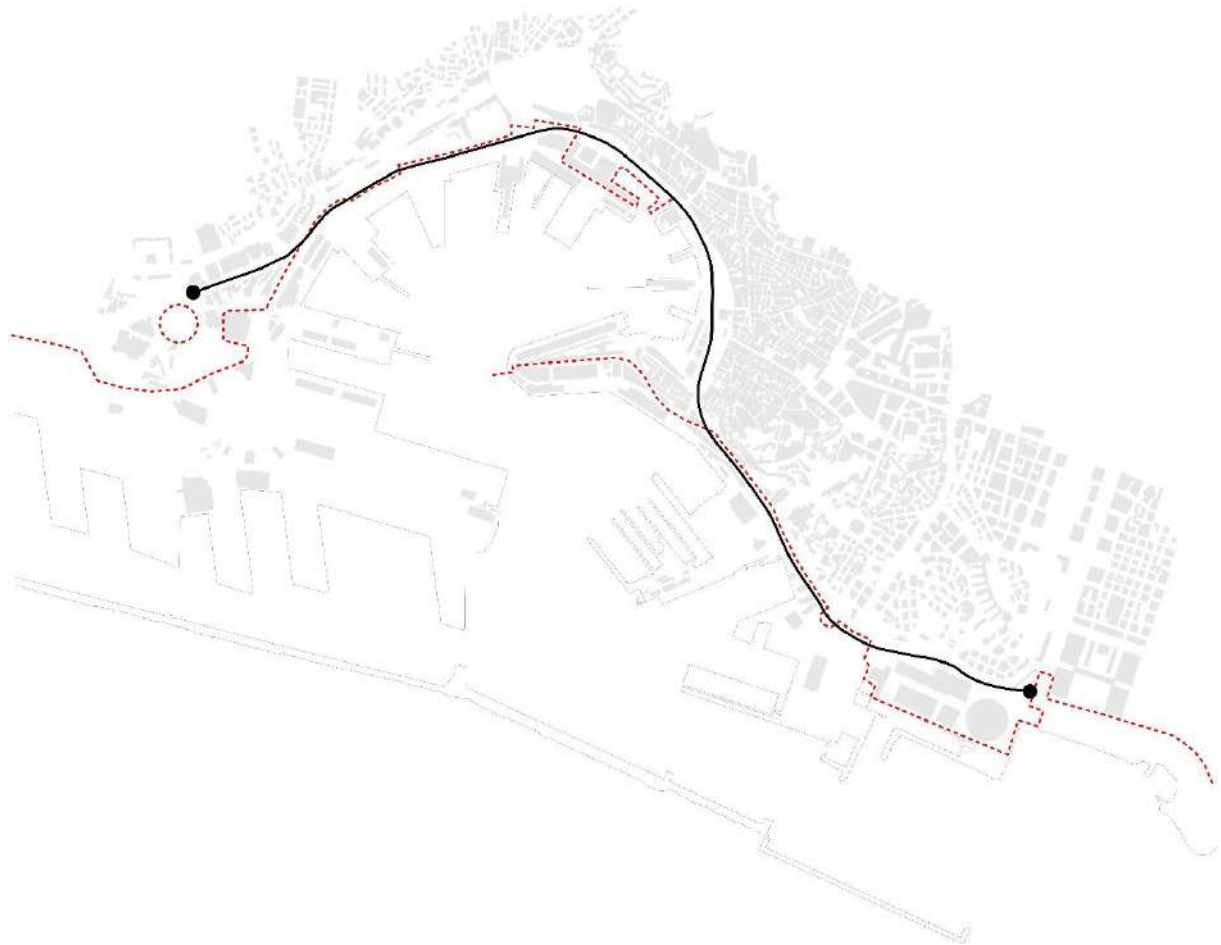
| Elaborazione estratta dalla planimetria generale raffigurante il tracciato della Sopraelevata Aldo Moro rispetto alla linea di confine demaniale aggiornato a luglio 2006.
